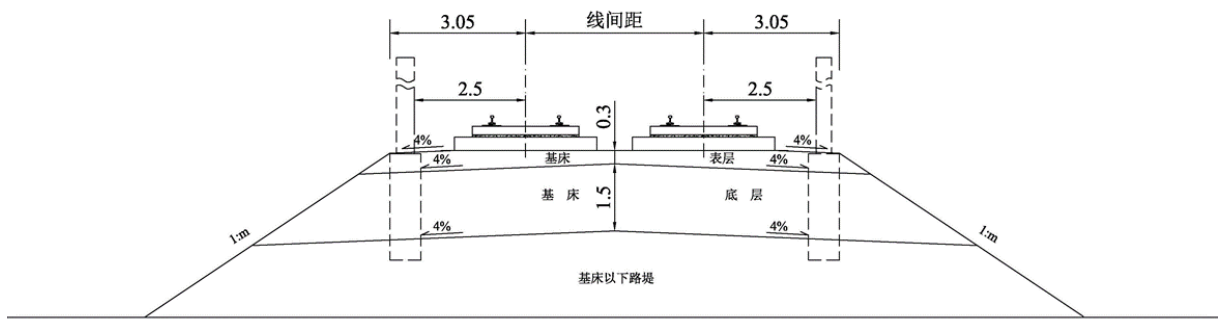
无砟轨道双线路堤横断面图 (单位: m)
